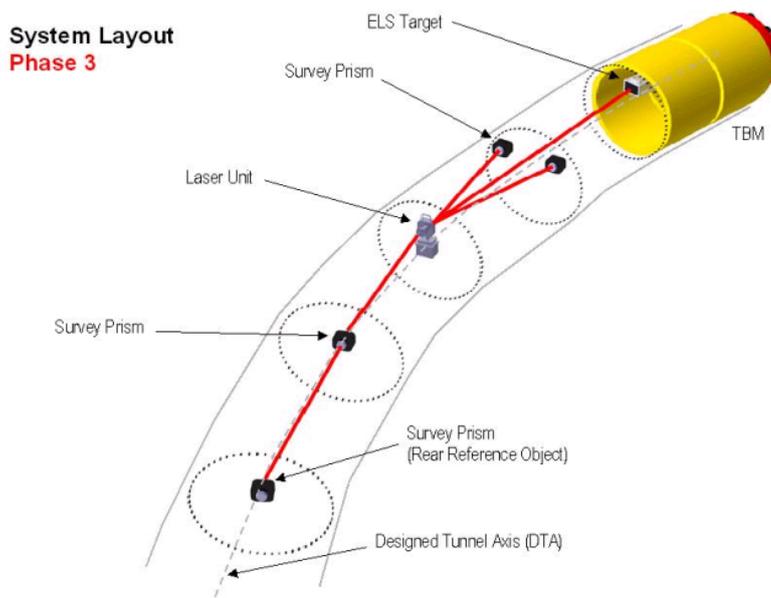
Aufbau des Steuerleitsystems für lange Trassen und Kurvenfahrten [14]
